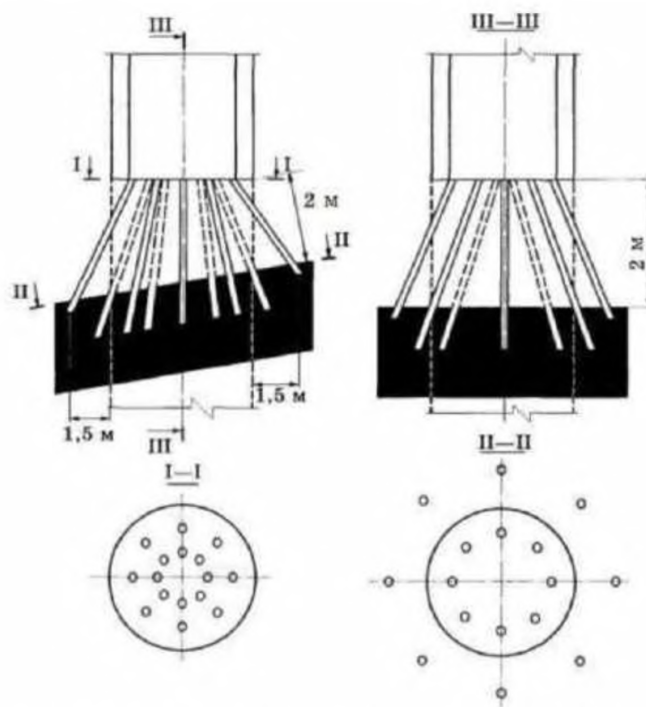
Схема расположения дренажных скважин при вскрытии угольных пластов наклонного и пологого залегания
